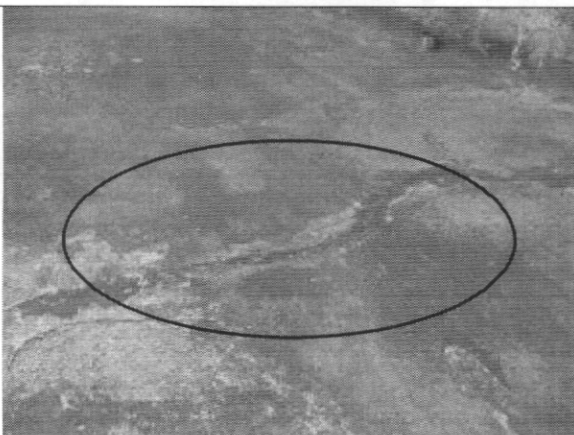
Fisura en placa de entepiso, sector norte
